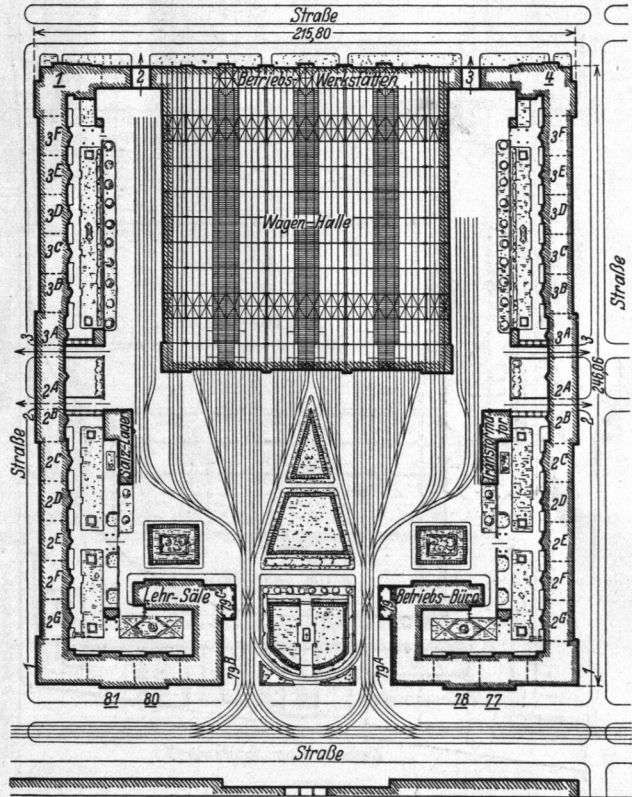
Der Lageplan eines Straßenbahnhofs wird von der Gleisanlage beherrscht. (Das Bild ist der Veröffentlichung von G. Mensch „Der neue Bahnhof Müllerstraße der Berliner Straßenbahn-Betriebs-G. m. b. H.“ Bauing. 1928, Heft 21 entnommen.)
